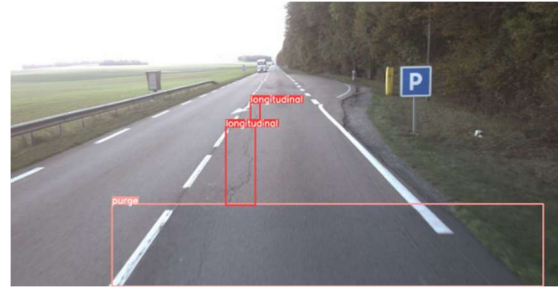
Exemple de fissures longitudinales et purge détectées sur la RN4 au PR 3+700
